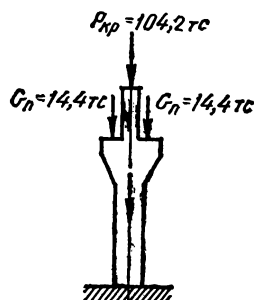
Расчетная схема от веса покрытия и подкрановых балок для колонны по оси Б.
